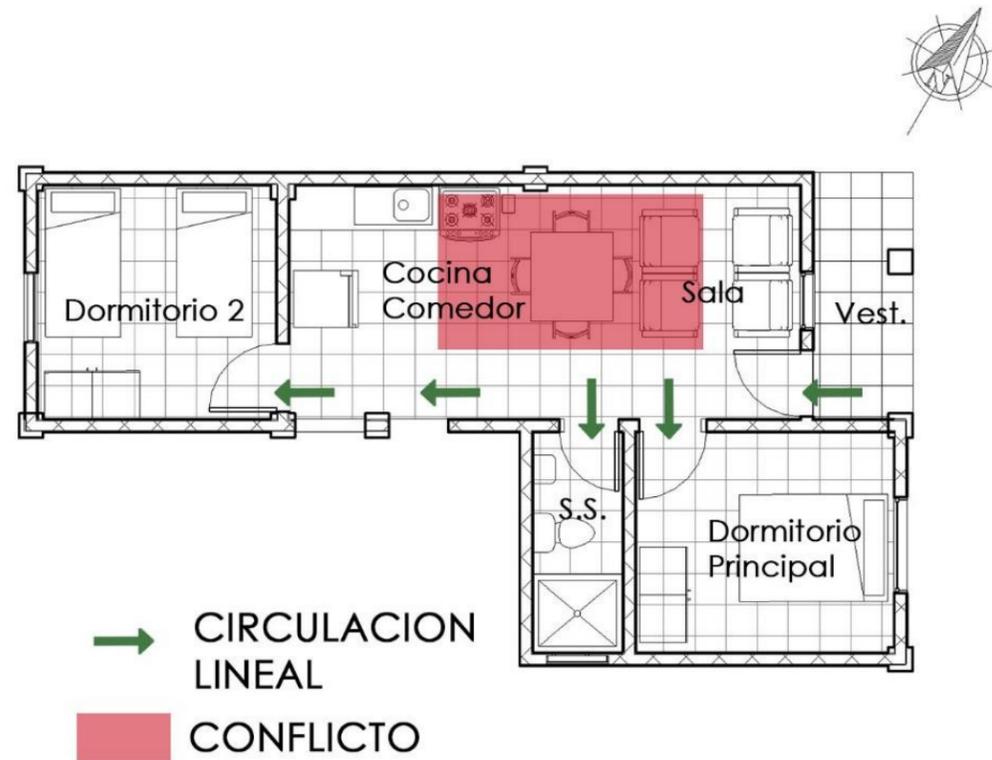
Planta arquitectónica de circulación de la vivienda Modelo propuesta por Masinfa / Holcim. Elaborada por las autoras a partir de planos proporcionados por Masinfa.
